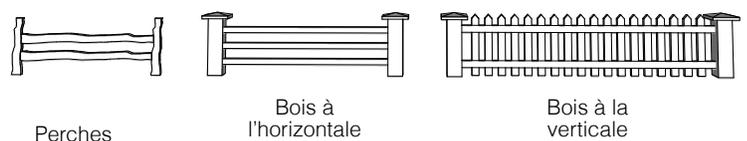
Clôture en bois, perches ou assemblage avec acier ou aluminium
